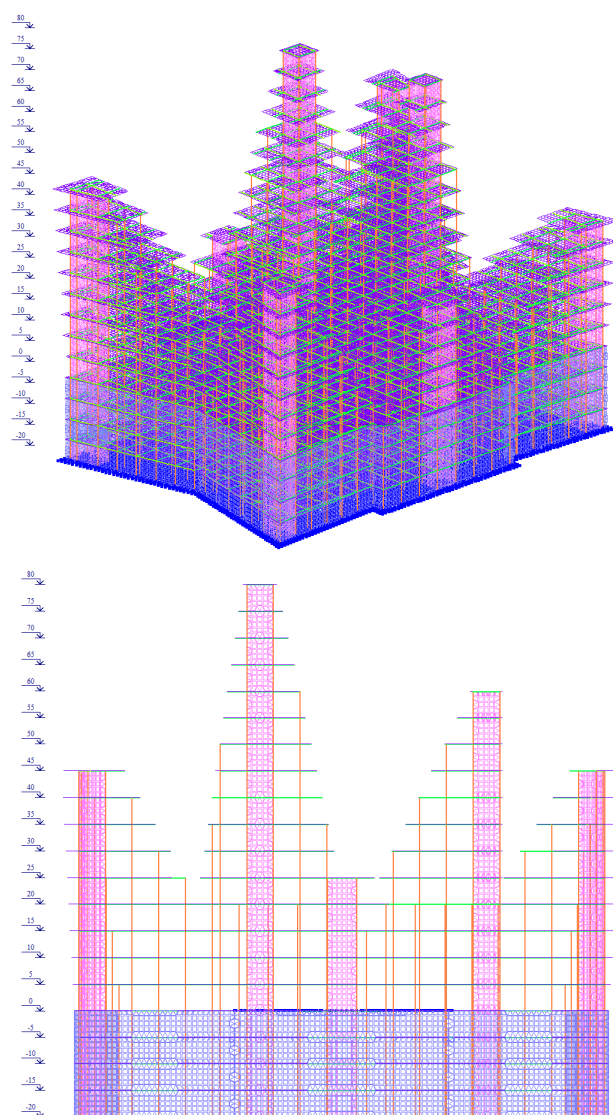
Расчетная схема 17-этажного здания с 4 уровневым подвалом
